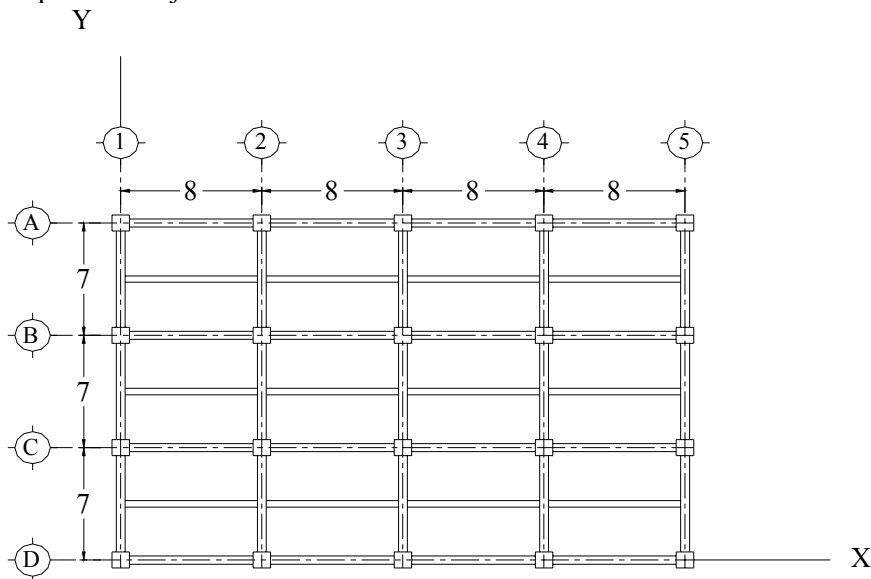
Planta Tipo del edificio estudiado por Luna (1999).
